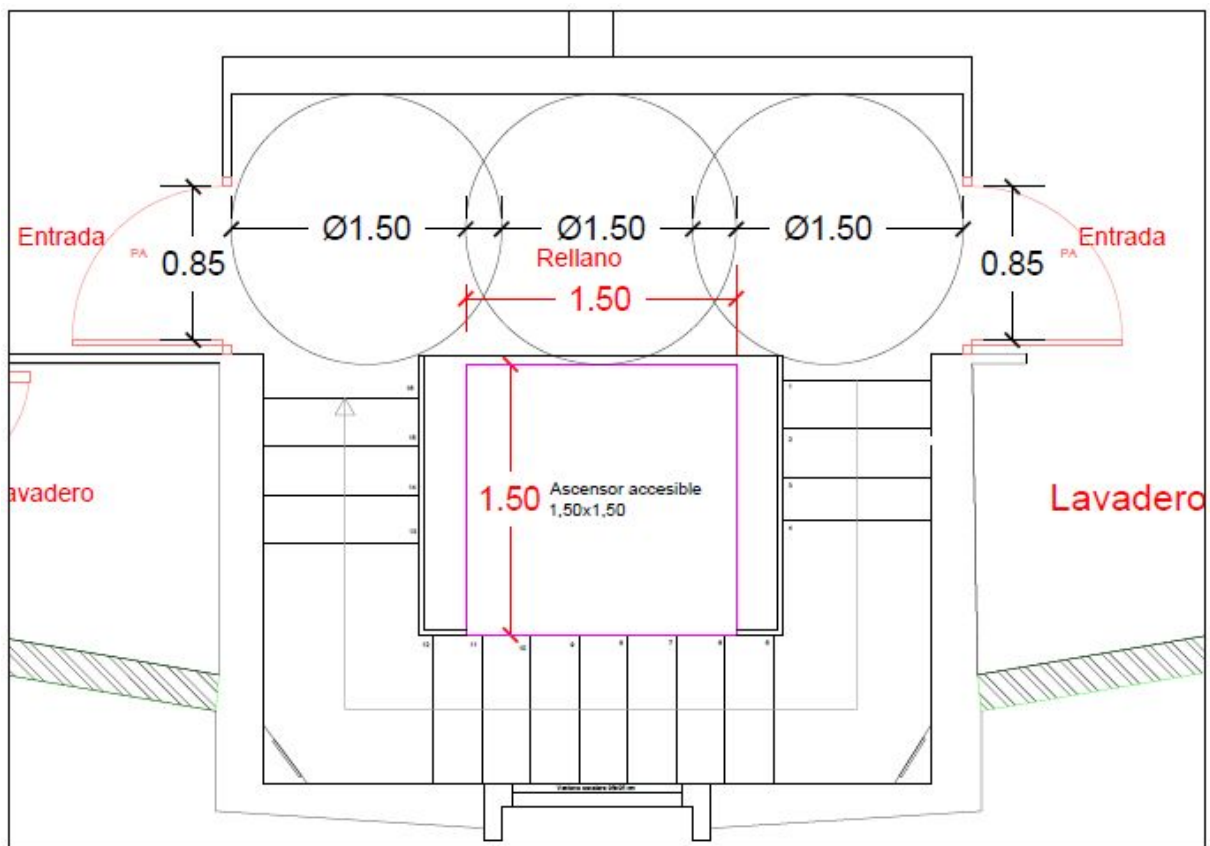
Propuesta 1 zona común PI Escalera 5 del bloque H (Fuente: Anejo D)
